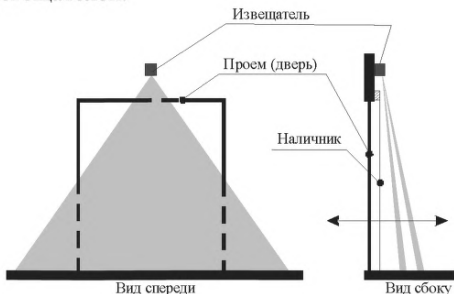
Применение поверхностных извещателей для блокировки дверного проема (извещатель установлен над проемом)
